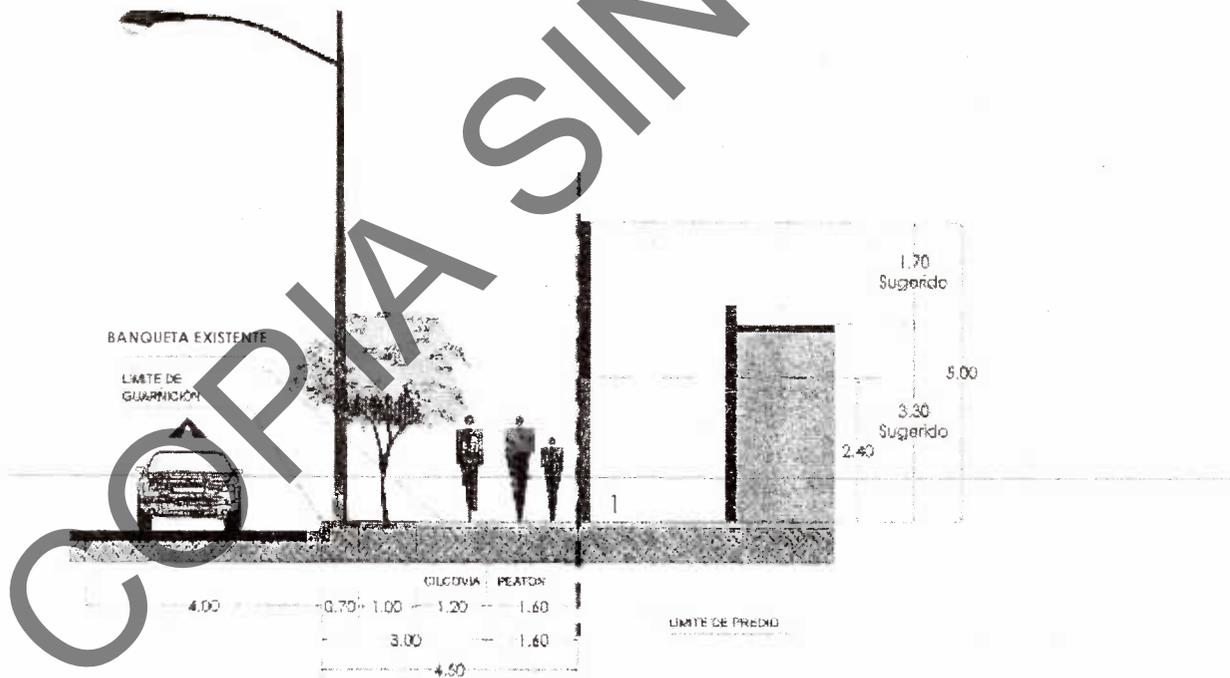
Detalle de Sección para construcciones con Patio y/o terraza al frente.
